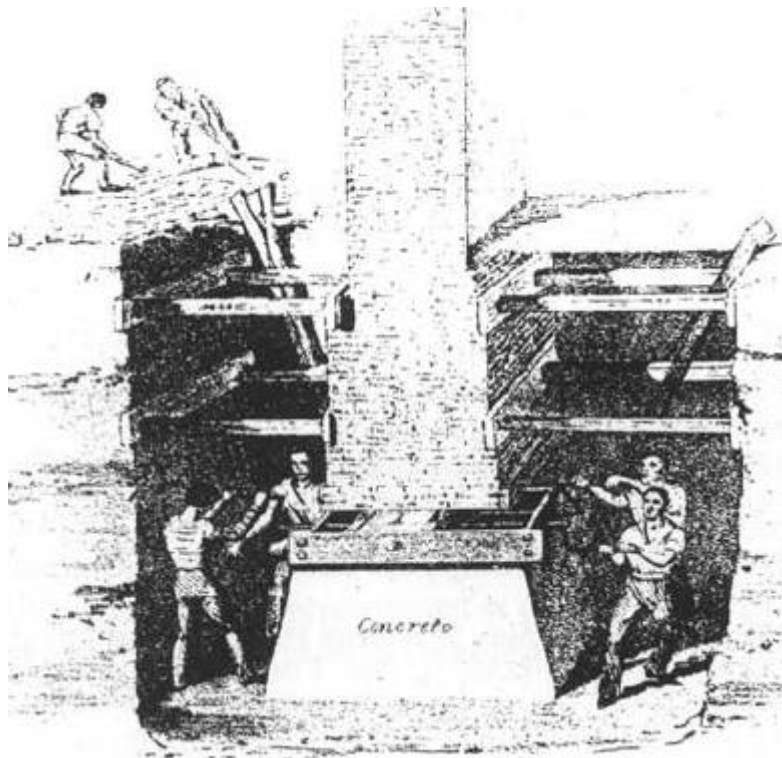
Reforço da fundação da parede através da construção da nova fundação de betão [84]
